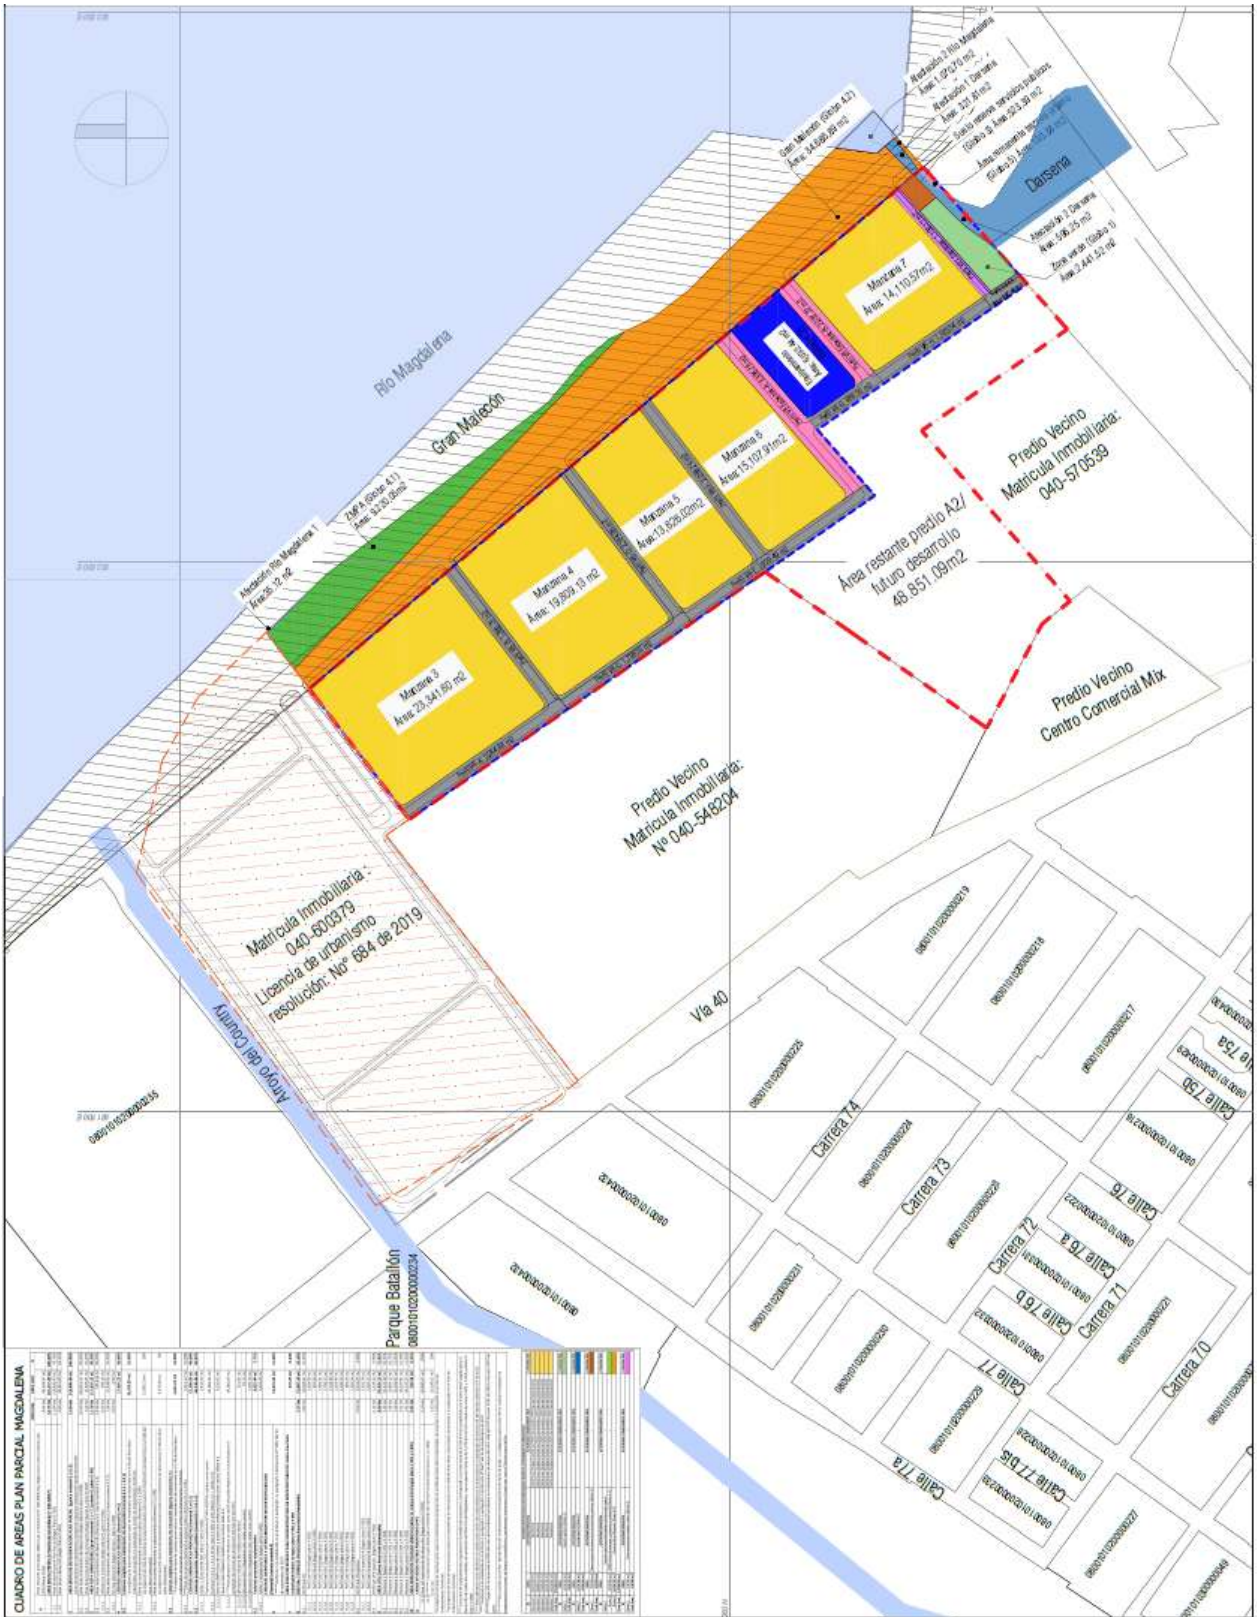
Planteamiento urbanístico Plan Parcial Magdalena. Ver plano anexo F-001
